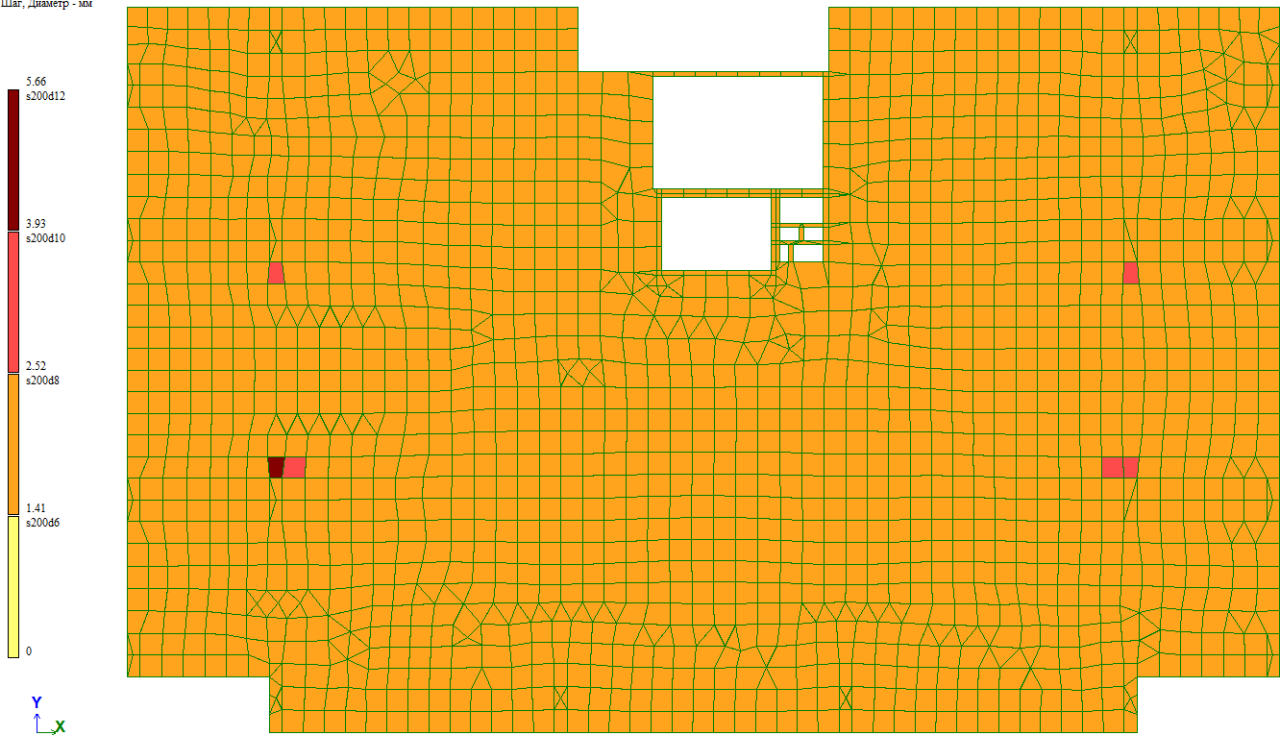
Верхне армивання плити першого поверху вздовж осіУ
